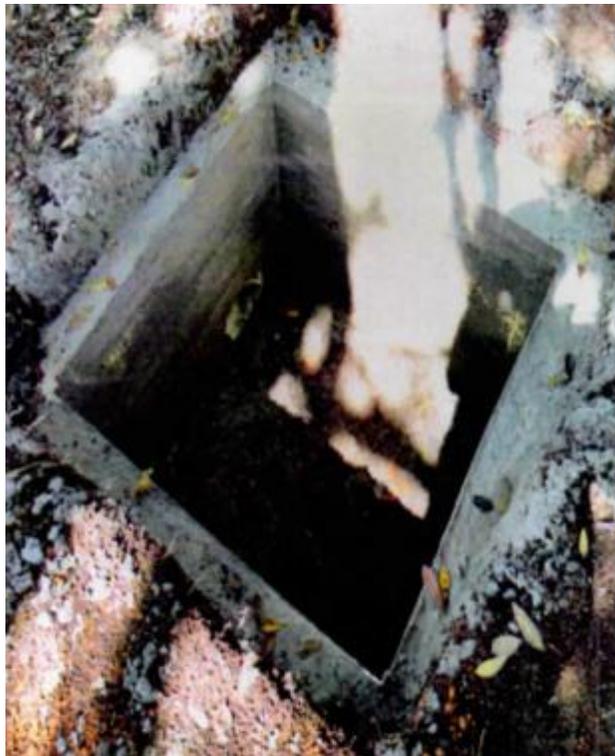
Construcción cajas de inspección en concreto (2/4).
